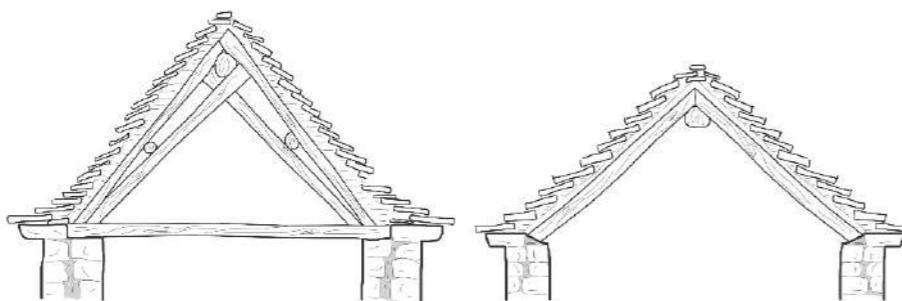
Croquis de la complejidad que puede adquirir la estructura de cubierta. Tijeras.
